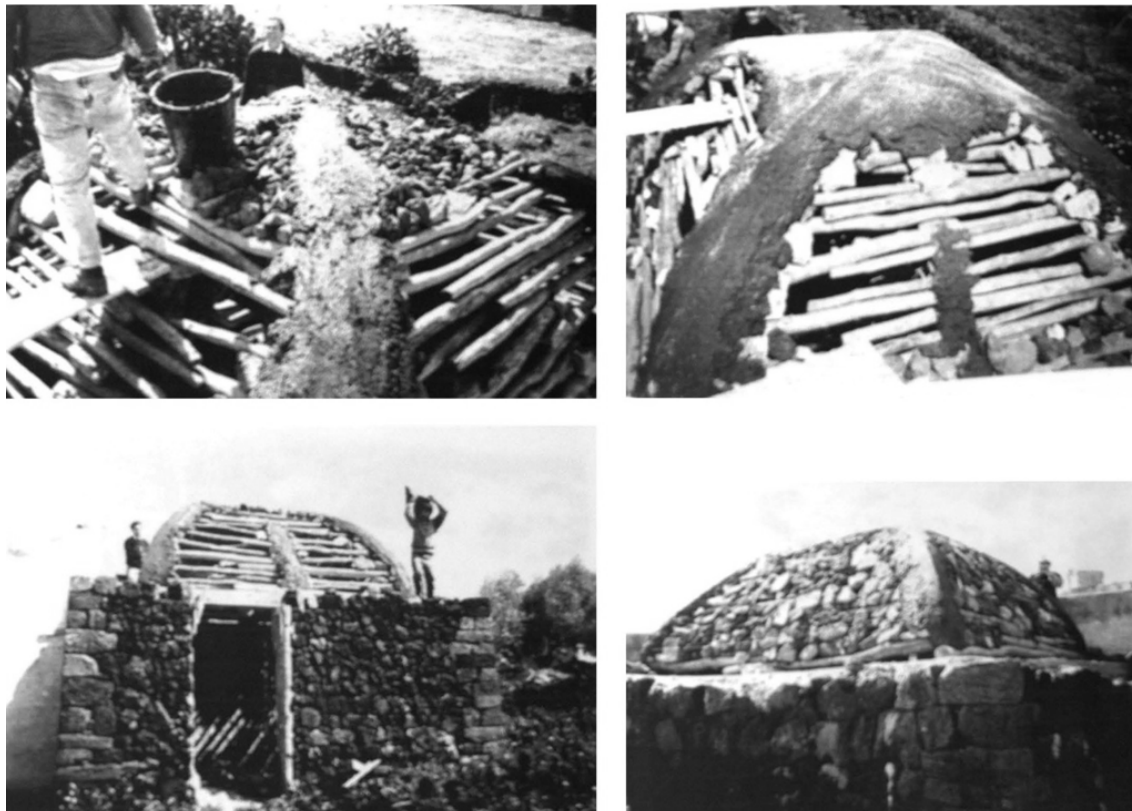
Técnica construtiva da abóbada de barrete de clérigo. Montagem dos cimbres (Minardi, 1998 pp. 70-71).
